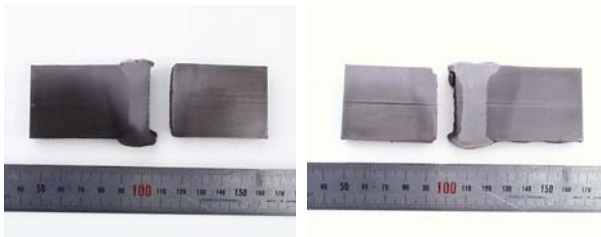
C B溶接用試験鉄筋のボンド部破断例
